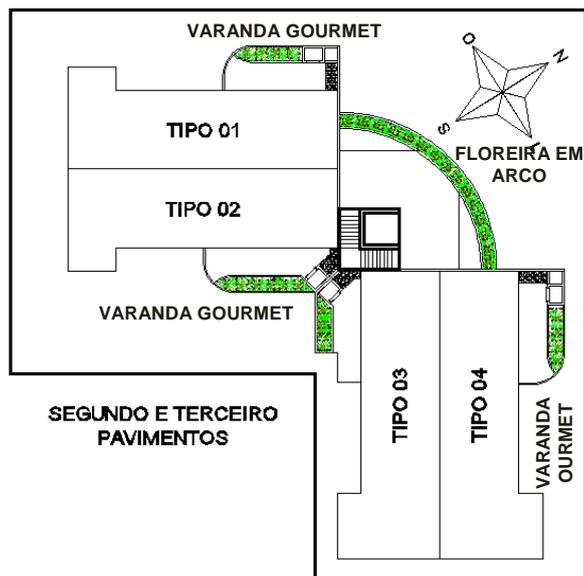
Layout paisagístico do segundo e terceiro pavimentos
